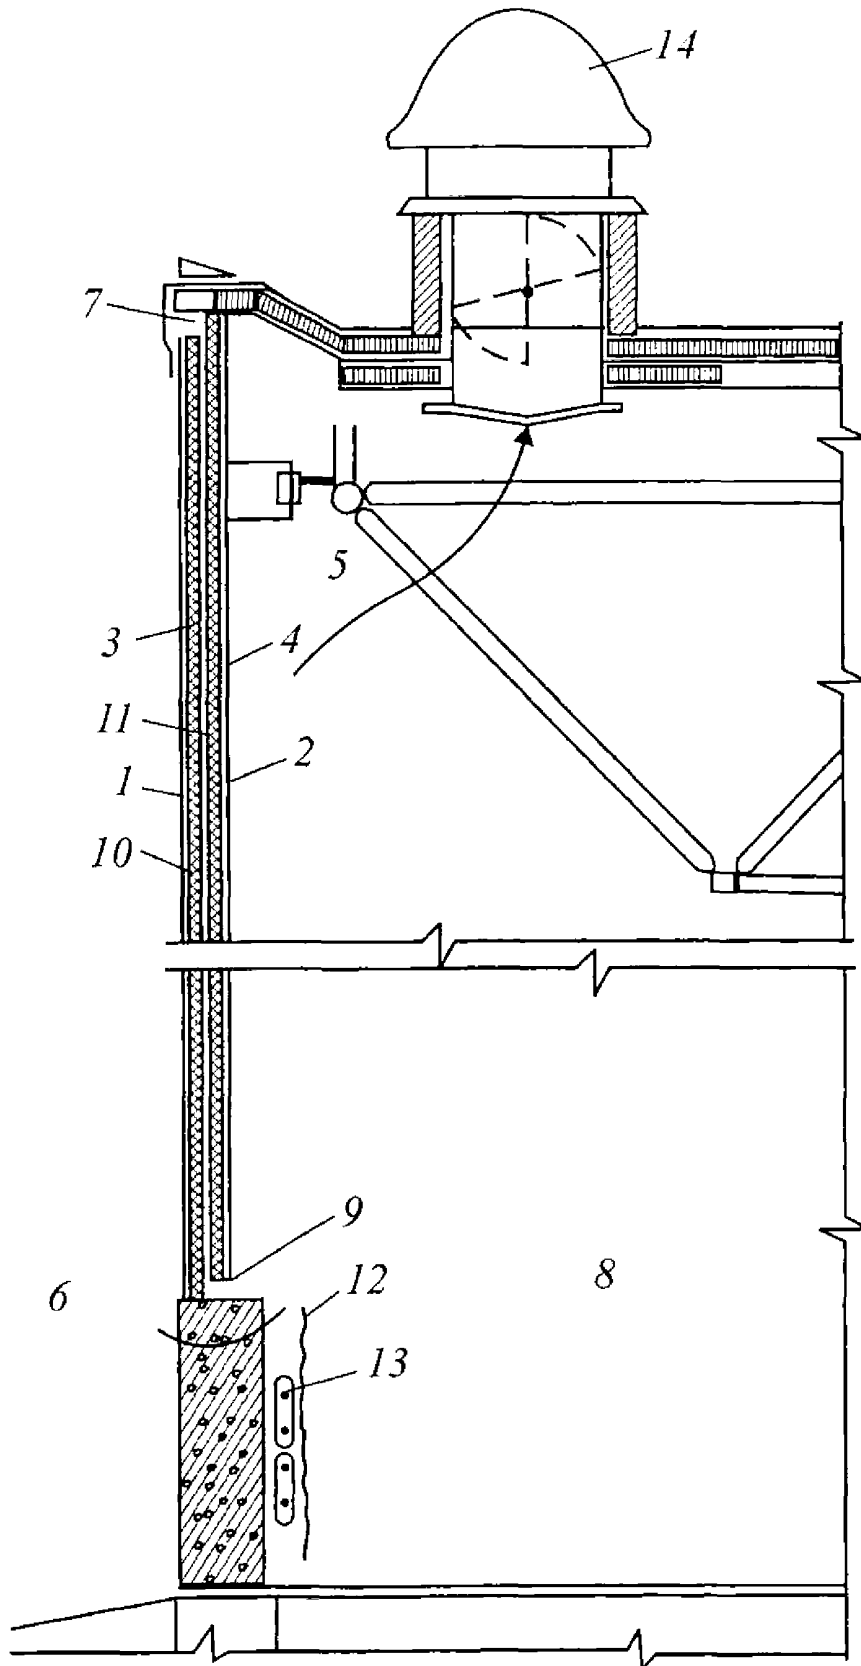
Наружное ограждение, совмещенное с системой вентиляции
